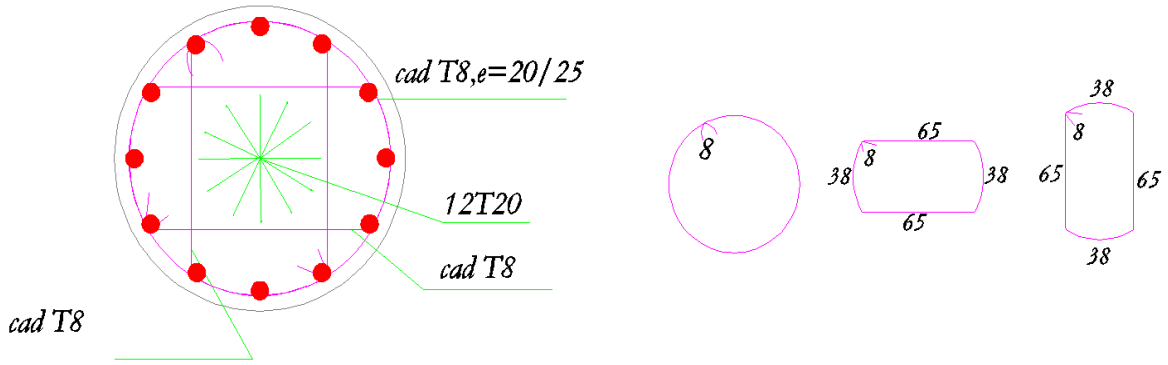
Schéma de ferrailage des poteaux C (D=75 cm)
